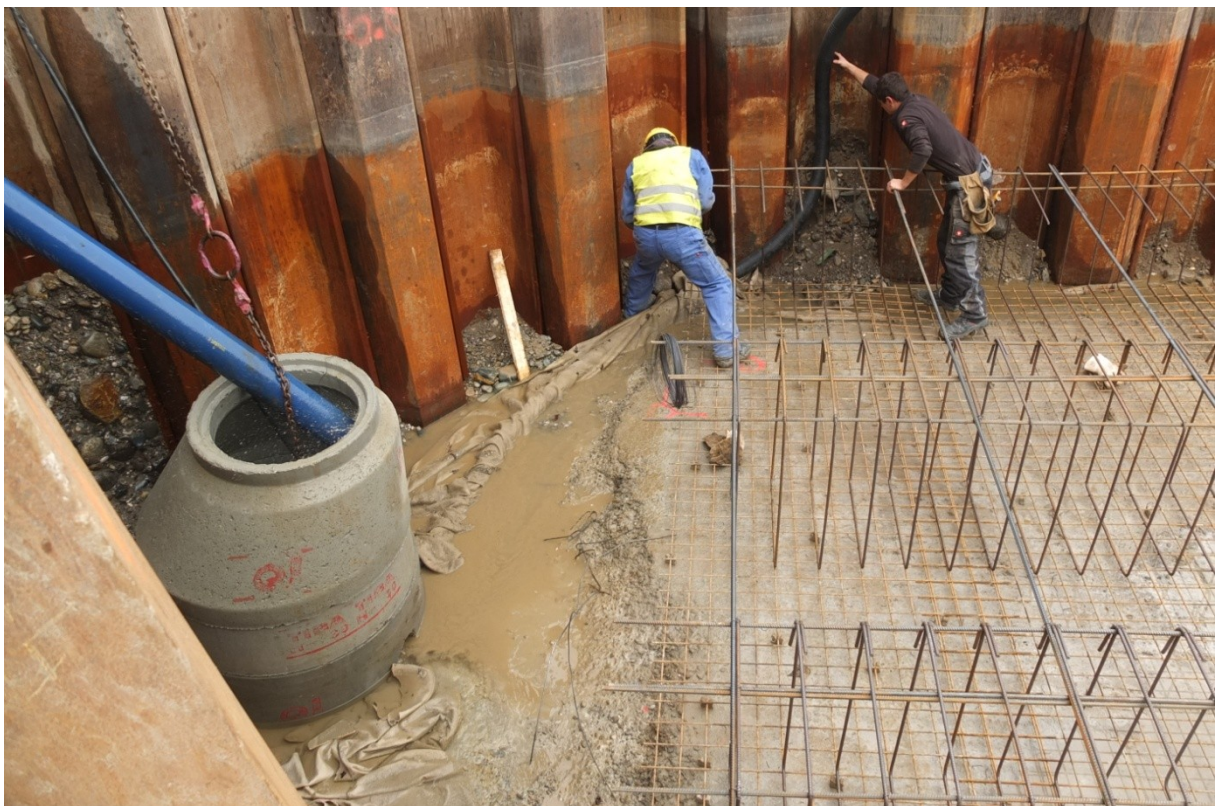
Betonierungsarbeiten im Inneren eines Spundwandkastens. Zur Bewältigung des Wasserandrangs wurde ein Brunnen gesetzt und Drainageschläuche verlegt. Das Baugrubenwasser wird in ein dafür errichtetes Absetzbecken gepumpt. Bauvorhaben: Neuerrichtung der Kugelsteinbrücke über die Mur, Gemeinde Peggau (2015)
